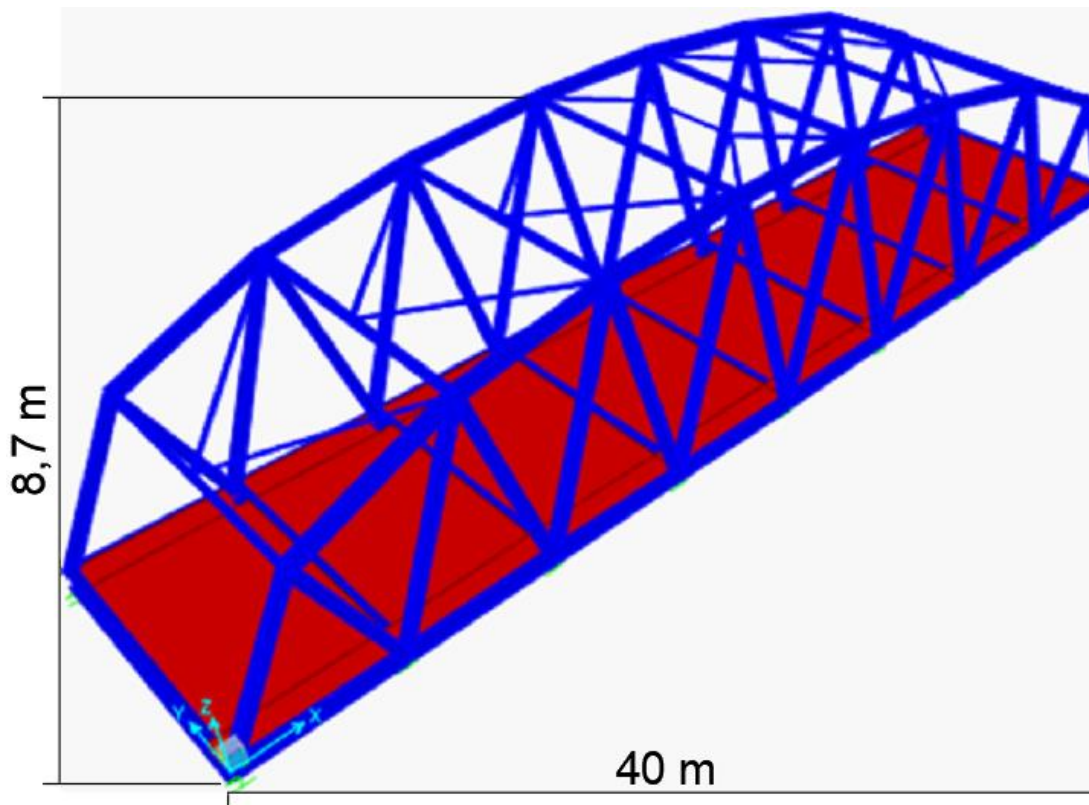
Desain Tampak Depan Jembatan *Warren Truss
